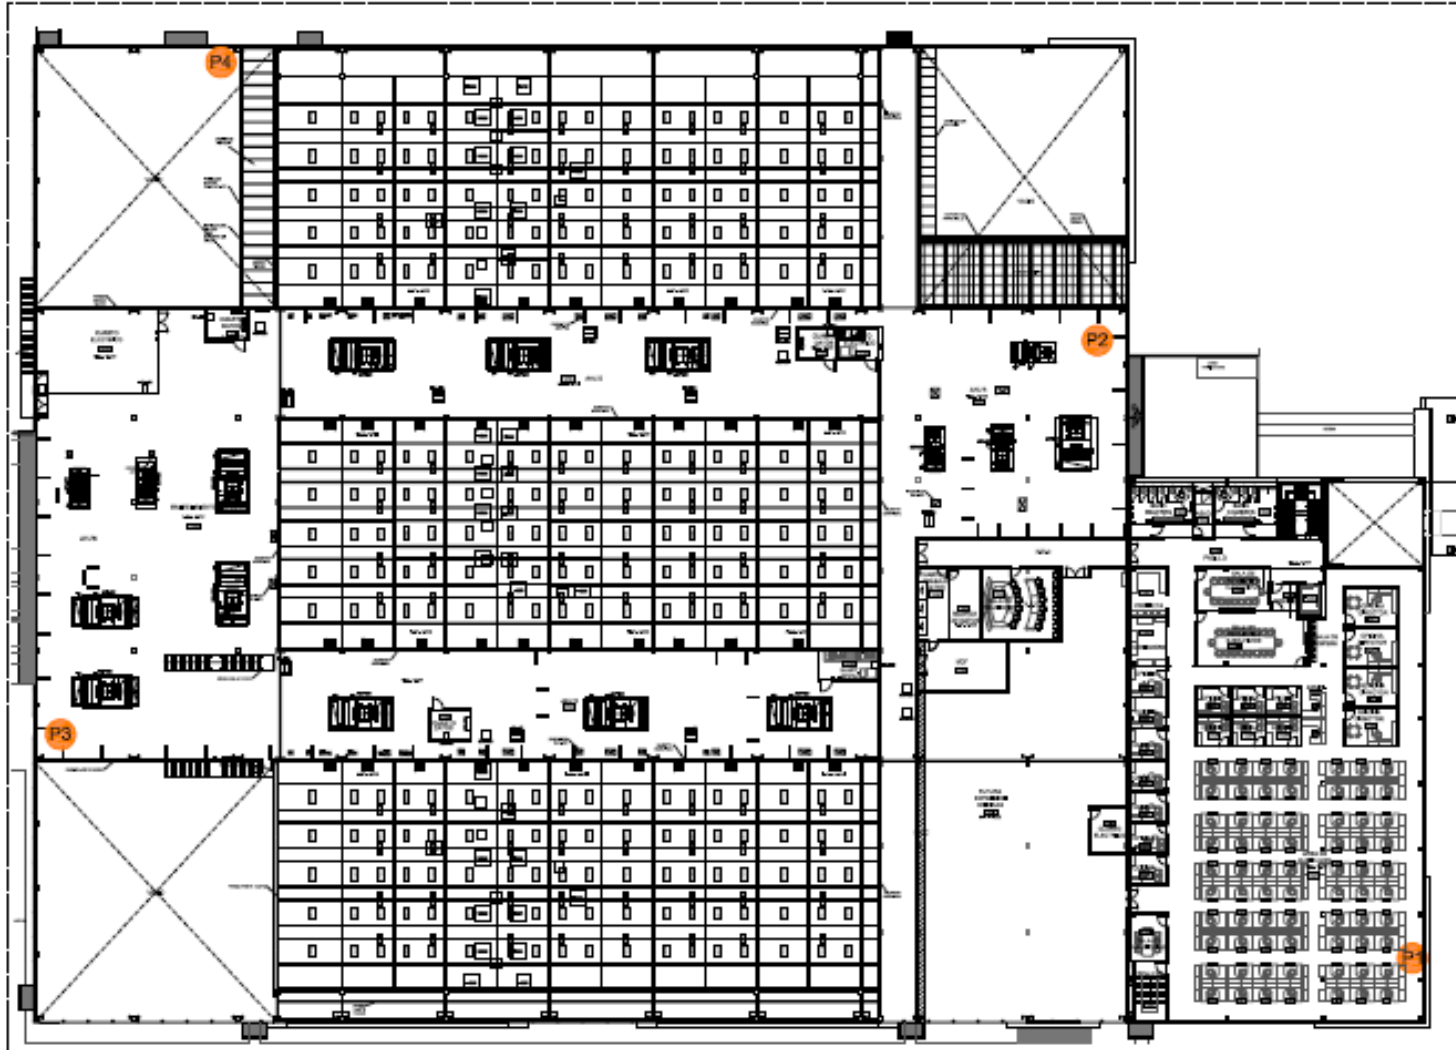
Diagrama de la planta AVCR para pruebas de rango.
